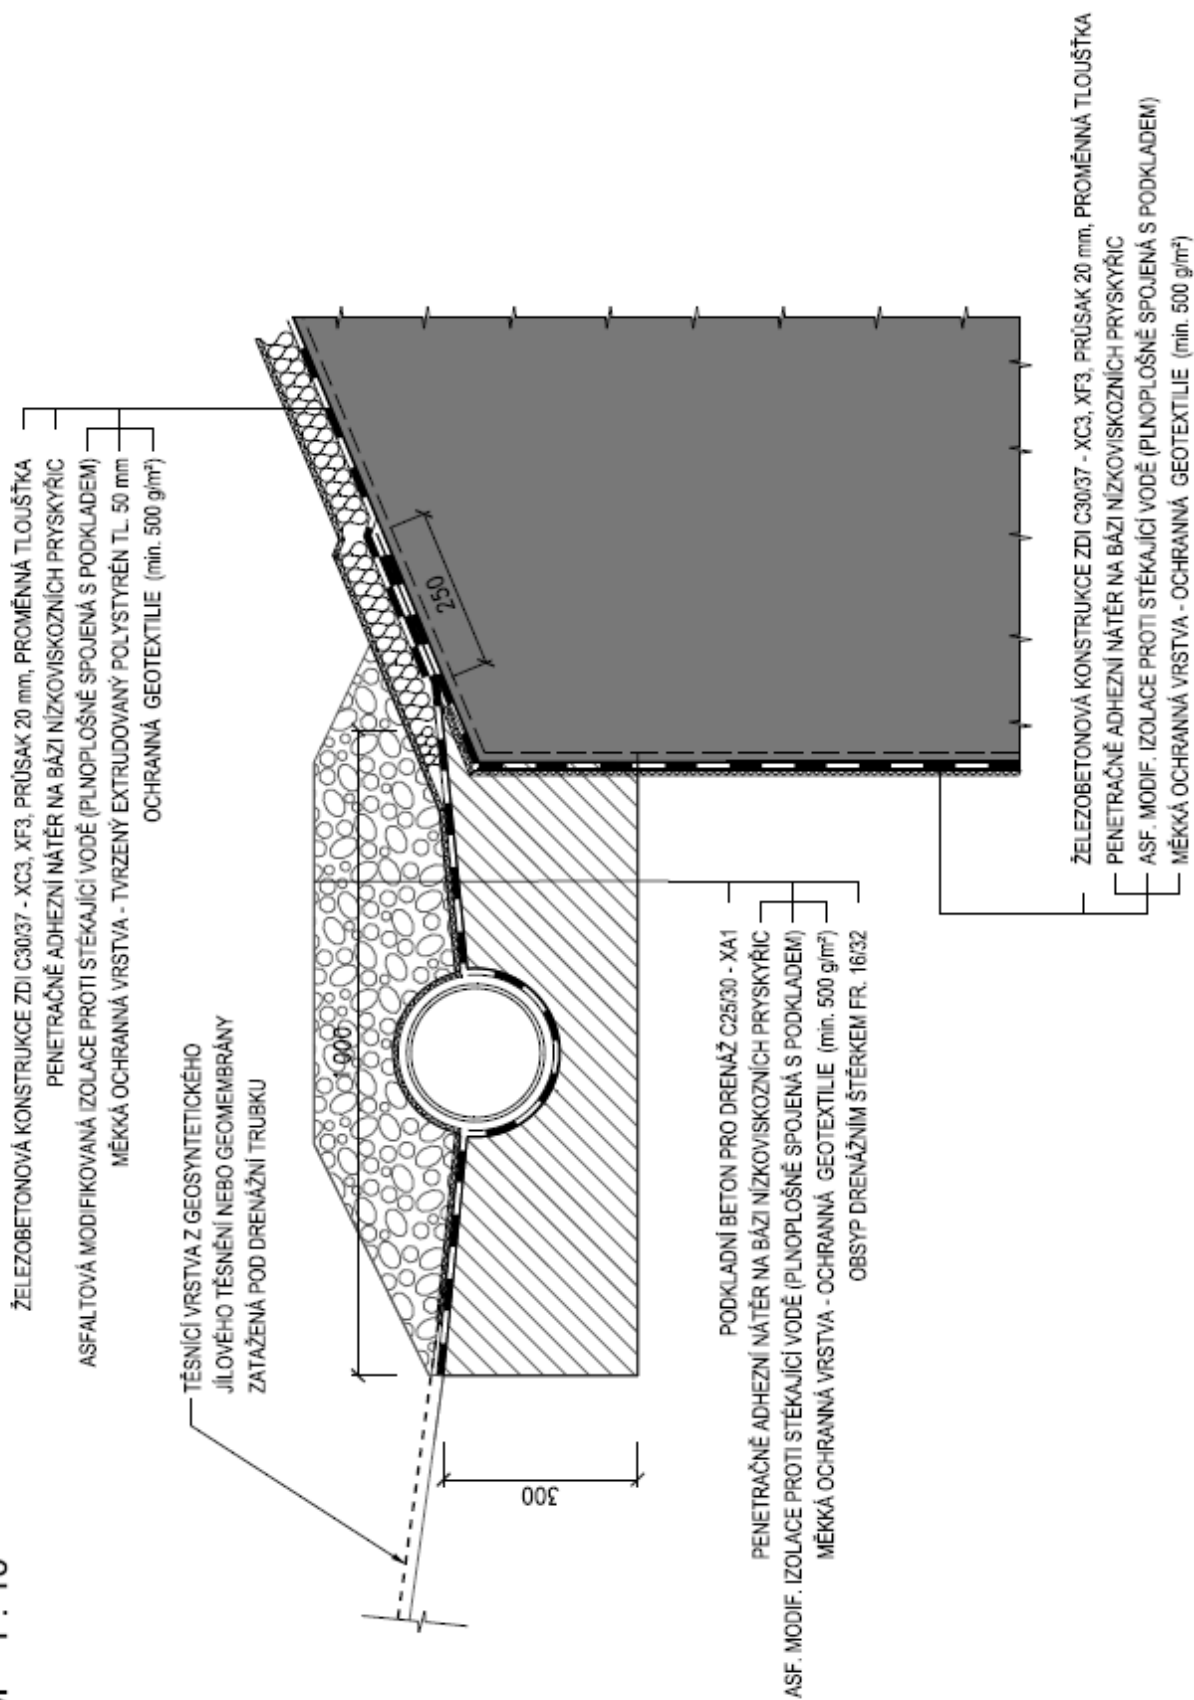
DILATAČNÍ SPÁRA POD DRENÁŽÍ
